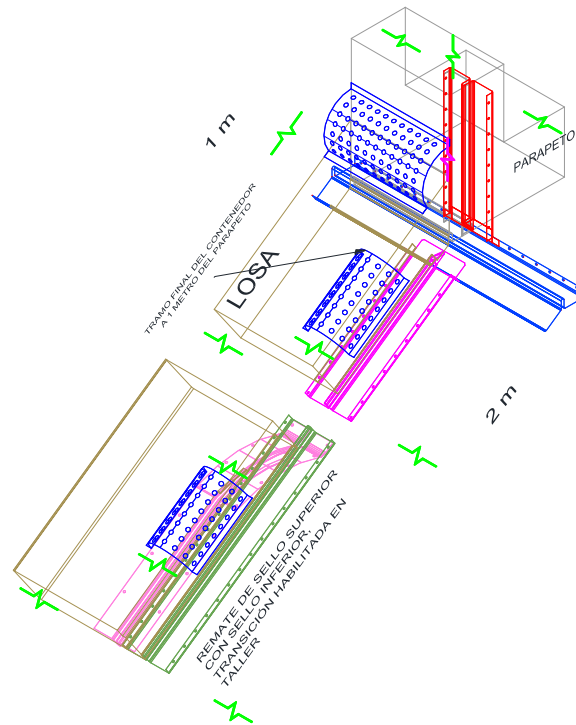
Junta de la Cara de Concreto con muro de Parapeto
